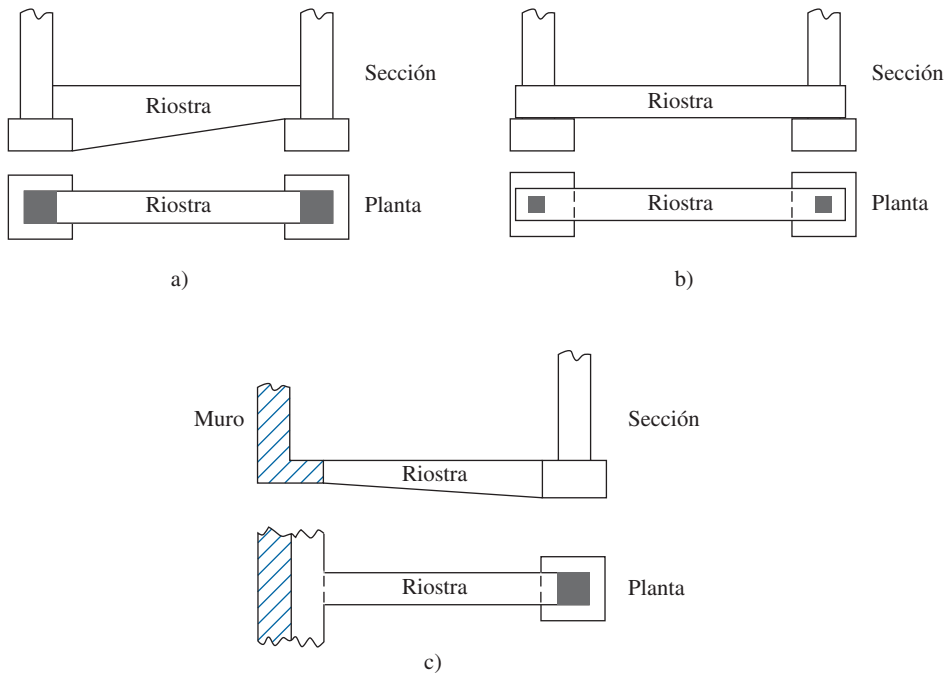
Zapata en voladizo: uso de una viga de arriostramiento.
